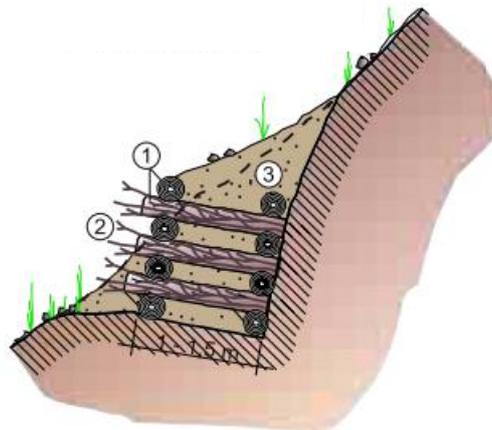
Muro cellulare in legname a parete doppia.
